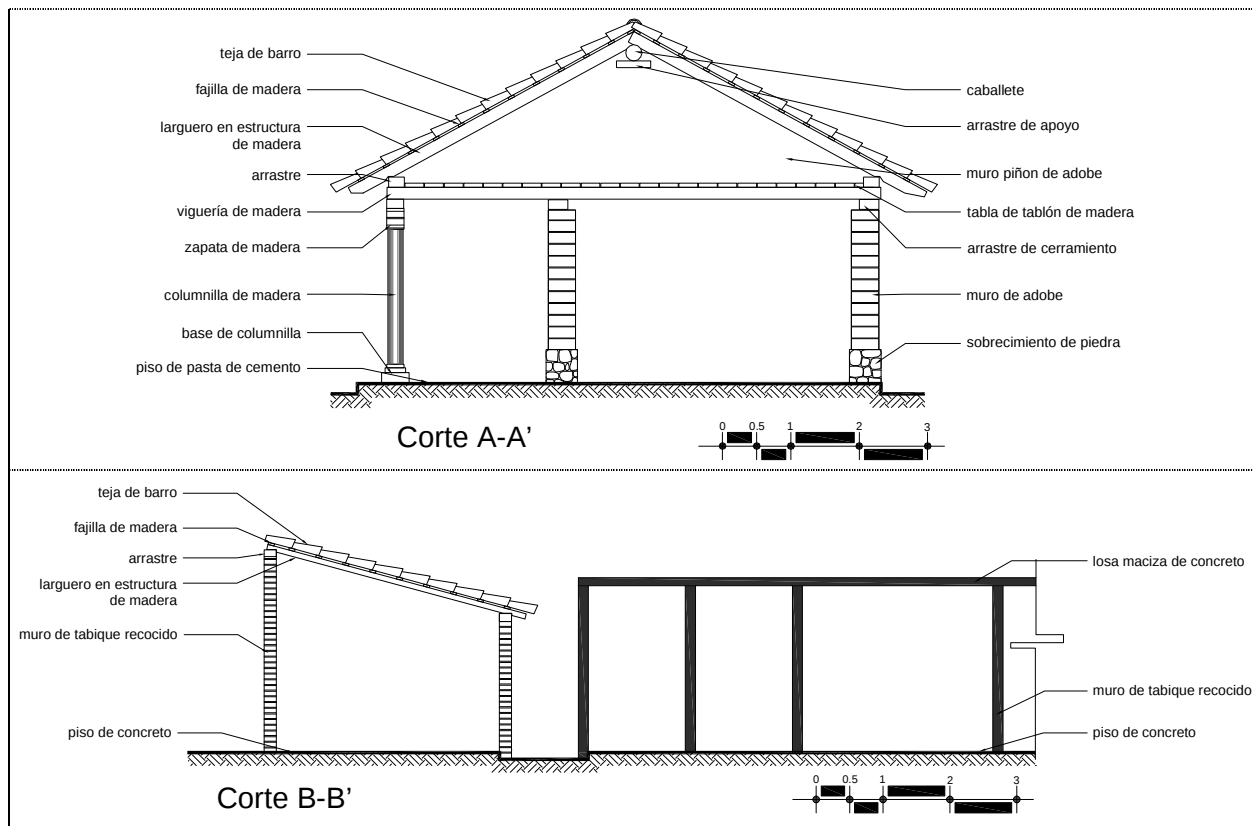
Distribución espacial en planta, fachada, corte y sistema constructivo de la vivienda vernácula híbrida. Fuente: croquis y fotografía aportación de la autora con base en levantamientos hechos en sitio.
